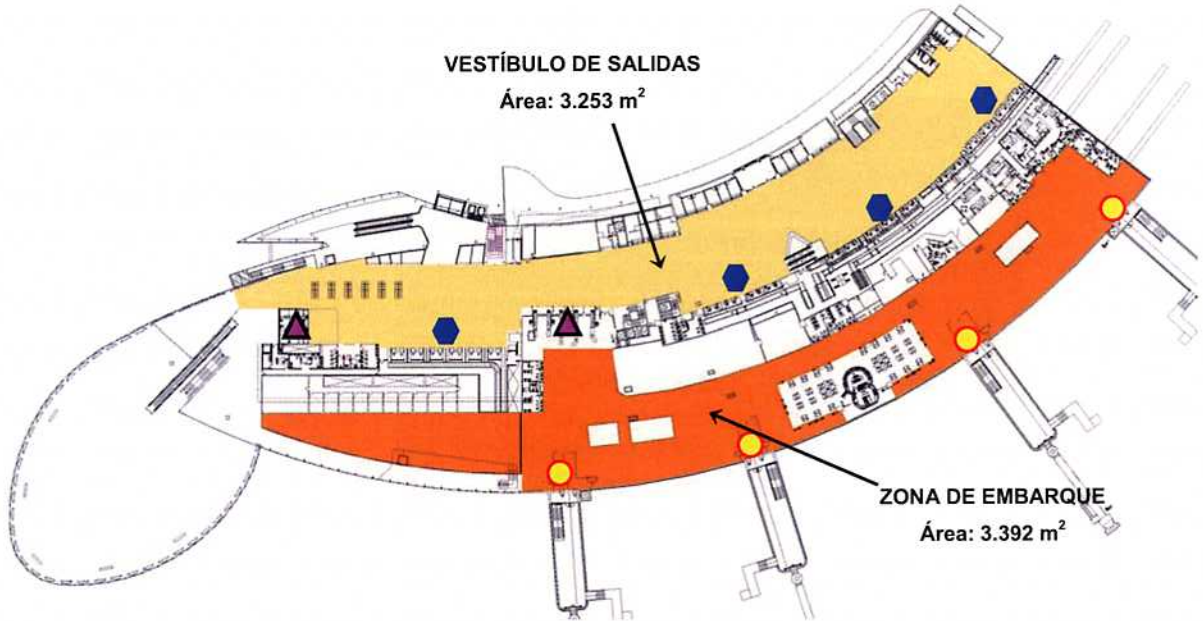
Instalaciones actuales del Edificio Terminal de Pasajeros. Planta primera
